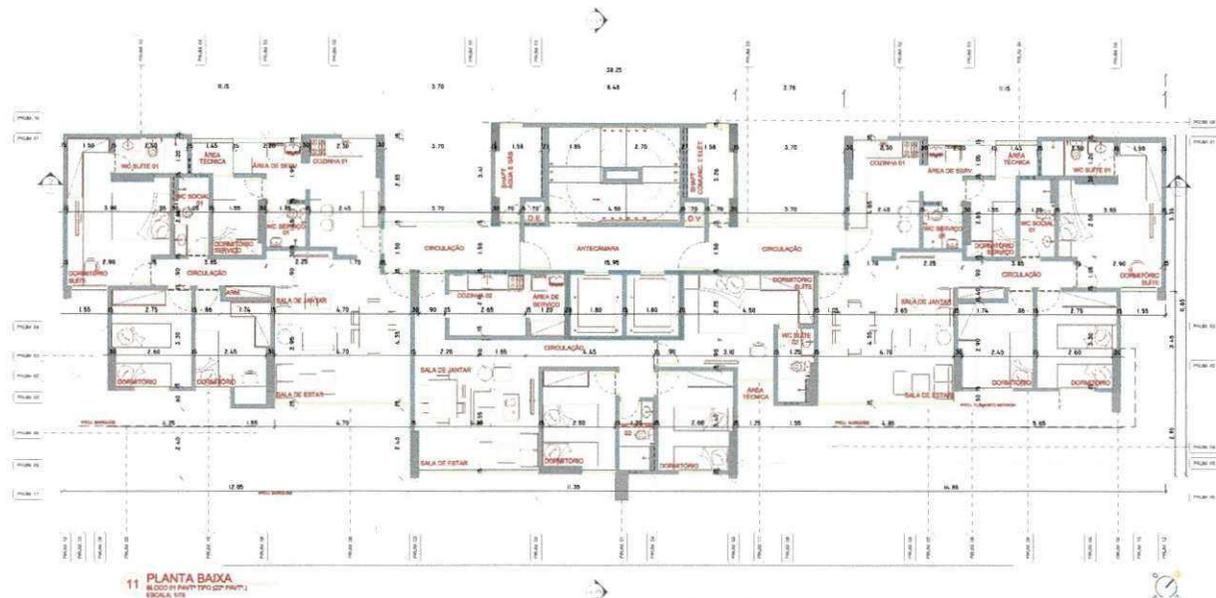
Projeto arquitetônico (Planta baixa pavimento tipo).
